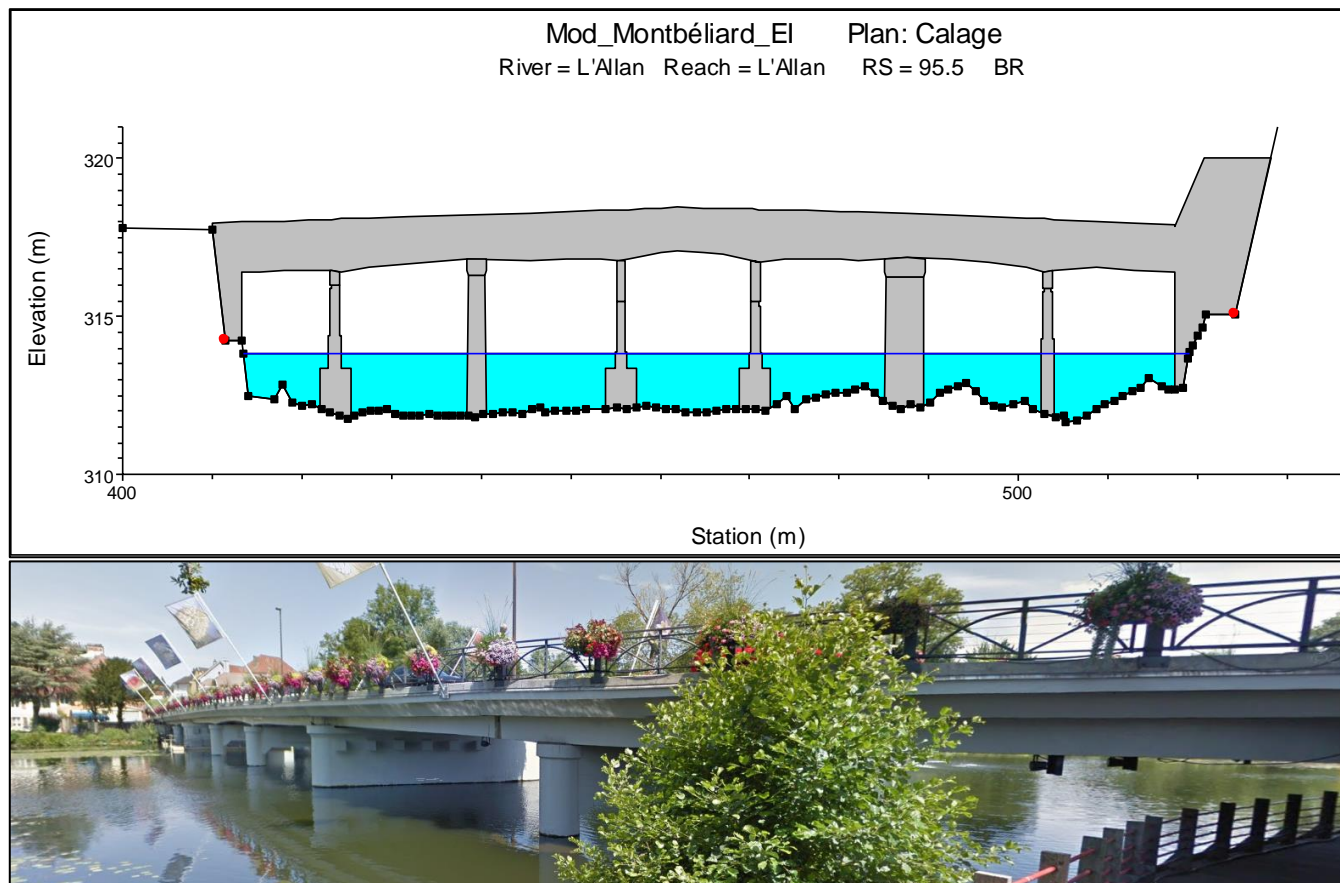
Profil en travers HEC-RAS et photo du pont de la RD438
